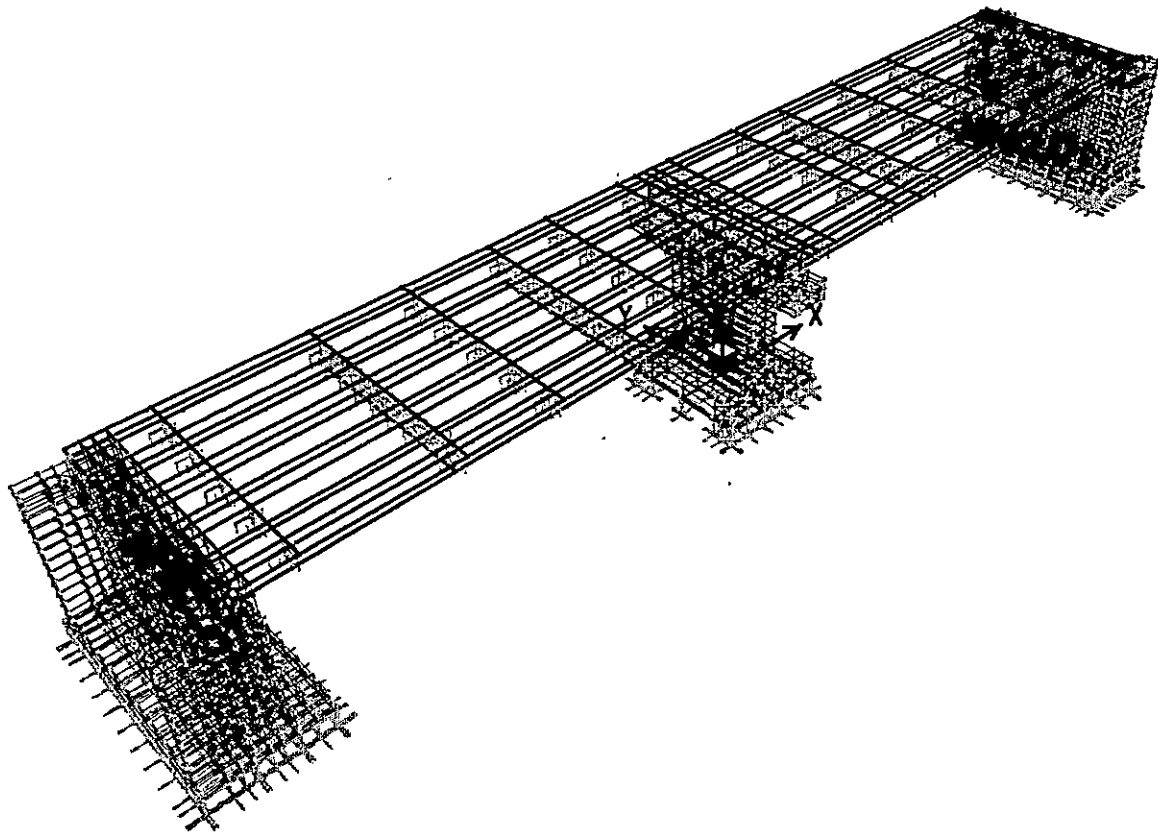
MODELO DEL PUENTE SAN ANTONIO.
